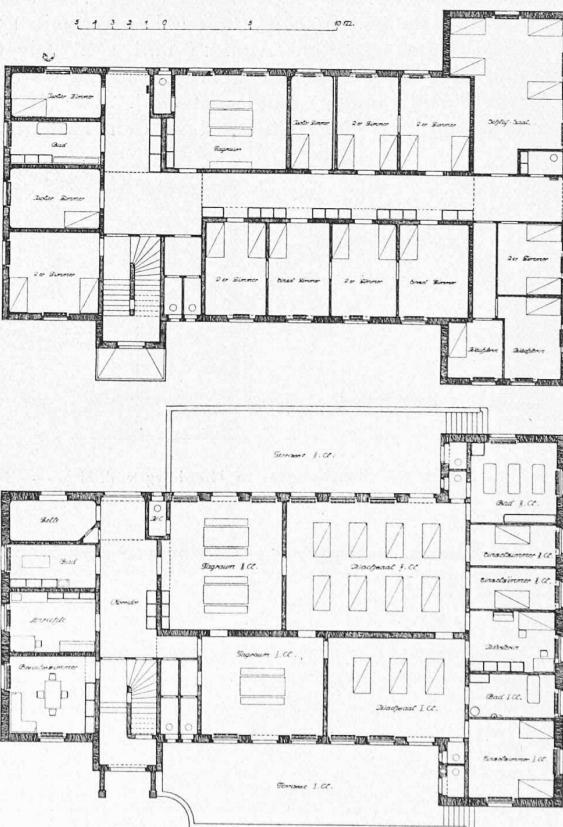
und 10. Pavillon für Unruhige. — Maßstab 1 : 400.
